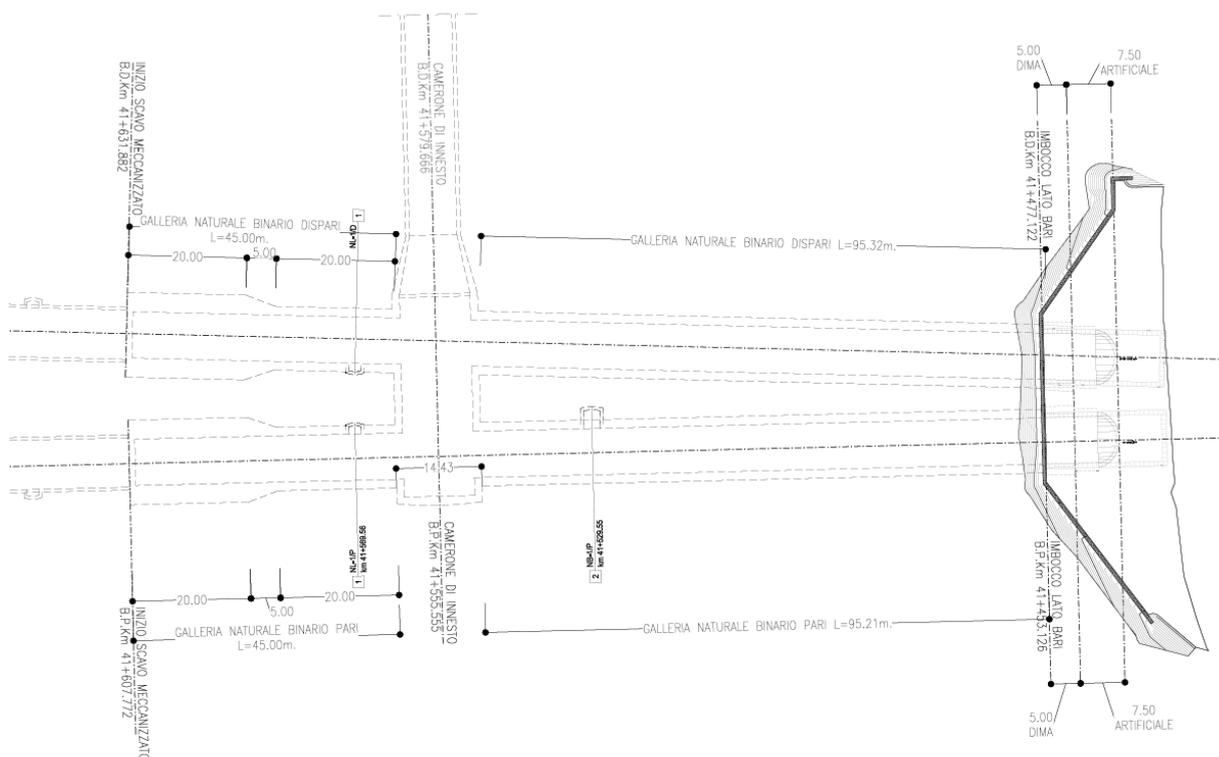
Planimetria generale tratta in tradizionale lato Bari
